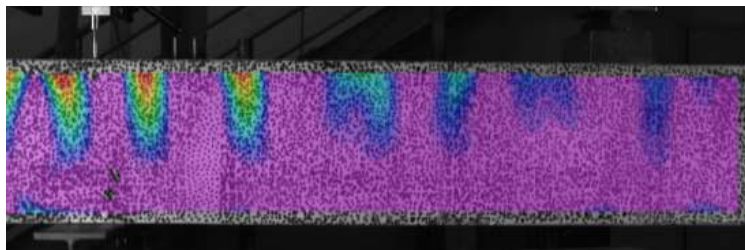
Exemple de fissures verticales dans la partie supérieure de la poutre NS-15 provoquées par l'application d'un moment négatif
